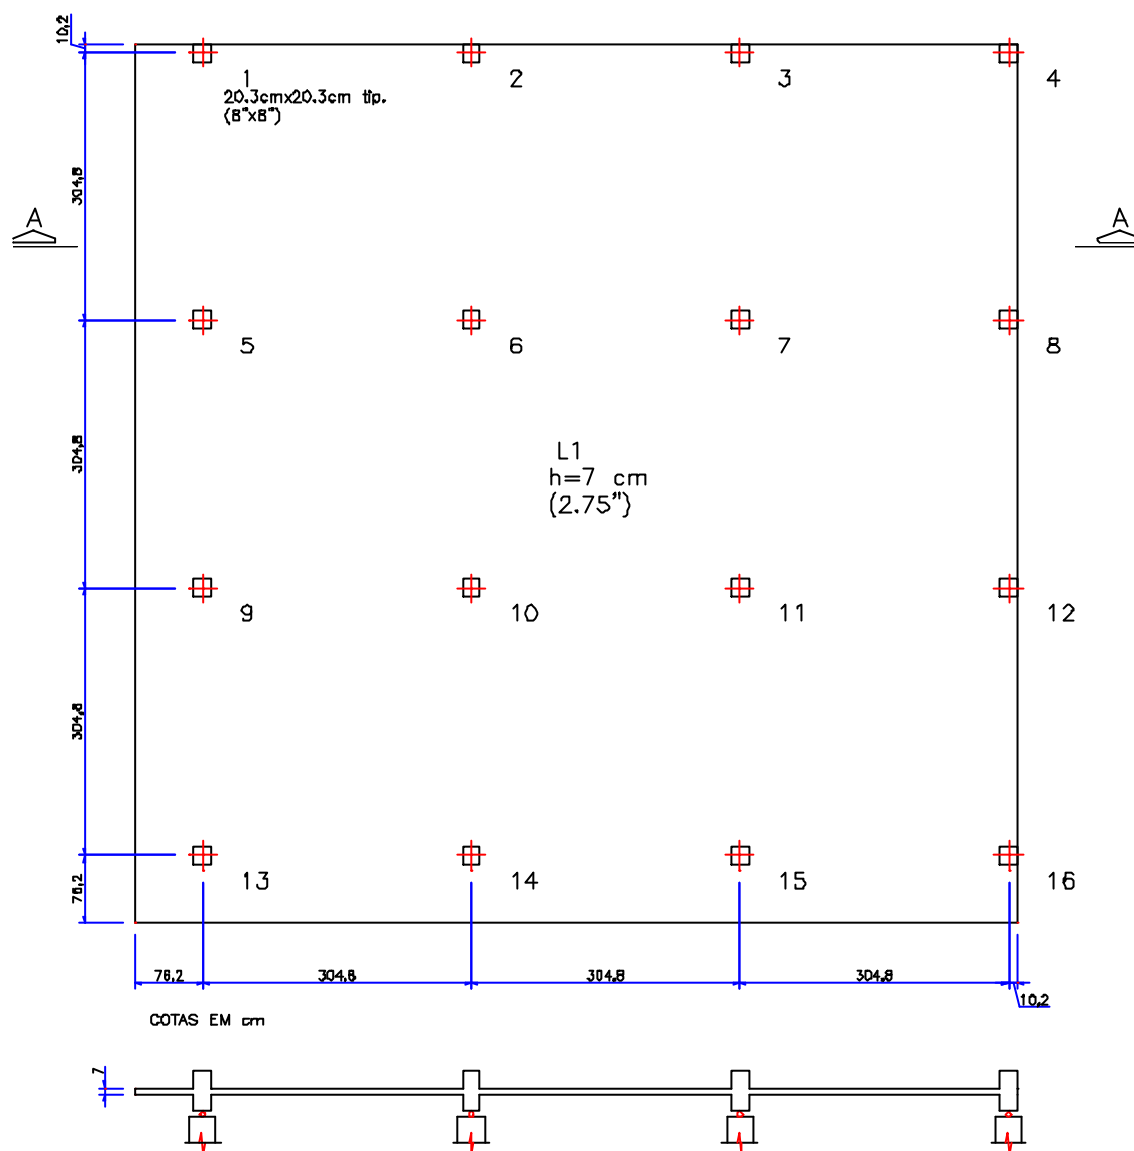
Planta e Elevação da Laje I – 1974
